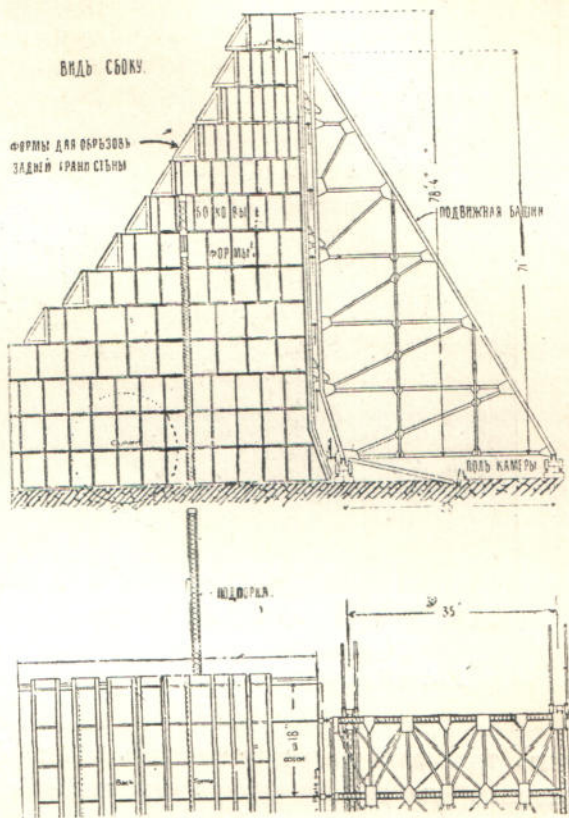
Видъ сбоку и половина плана башенныхъ формъ для отливки боковой шлюзной стѣны.
